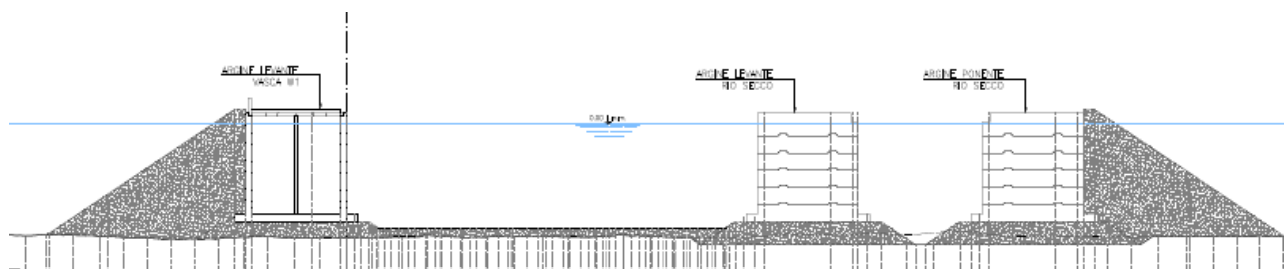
Sezione trasversale di progetto della Vasca W1 Bacino Sud e Rio Secco
